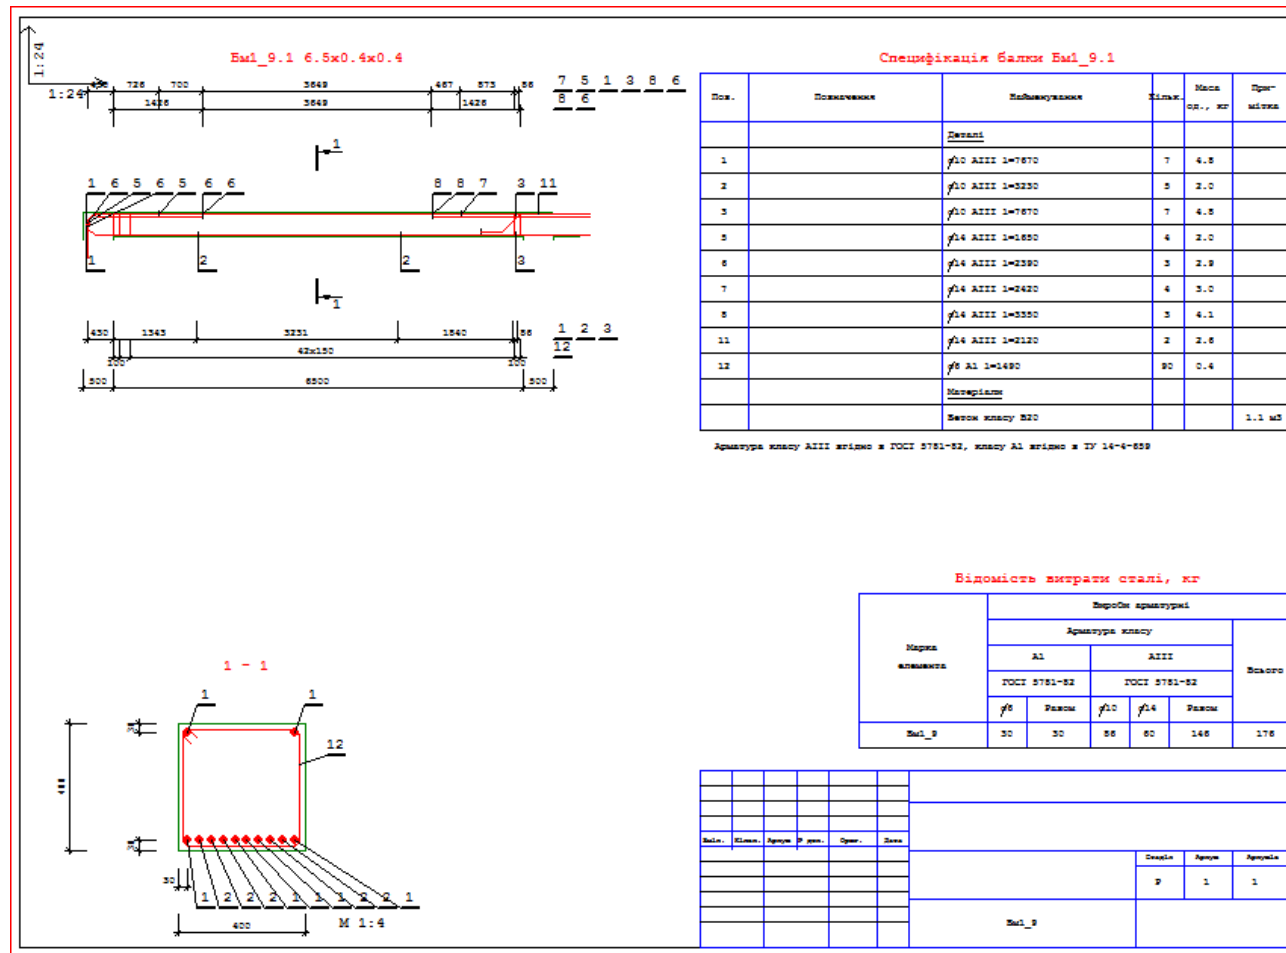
Варіант балково-плитного перекриття. Балка 1-9-1. Креслення робочого проекту
